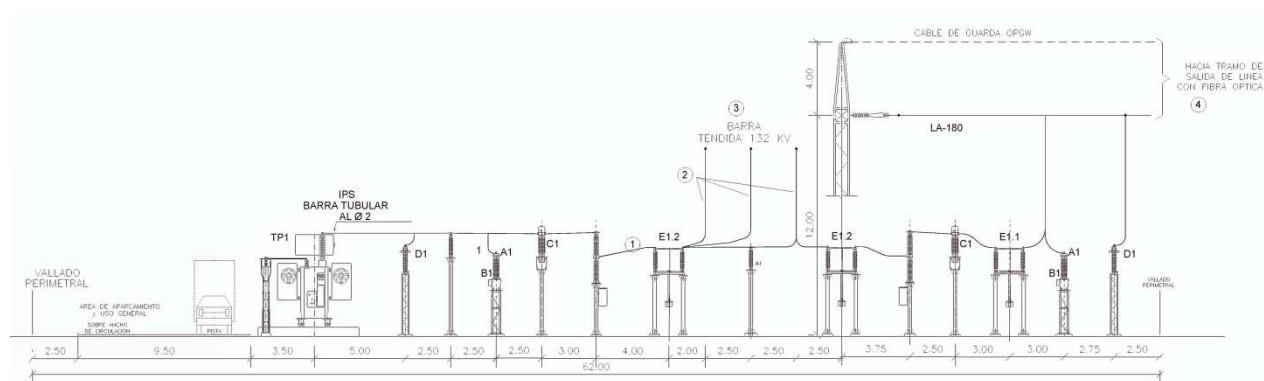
Vista de Alzado SET Linde 30/132 kV
